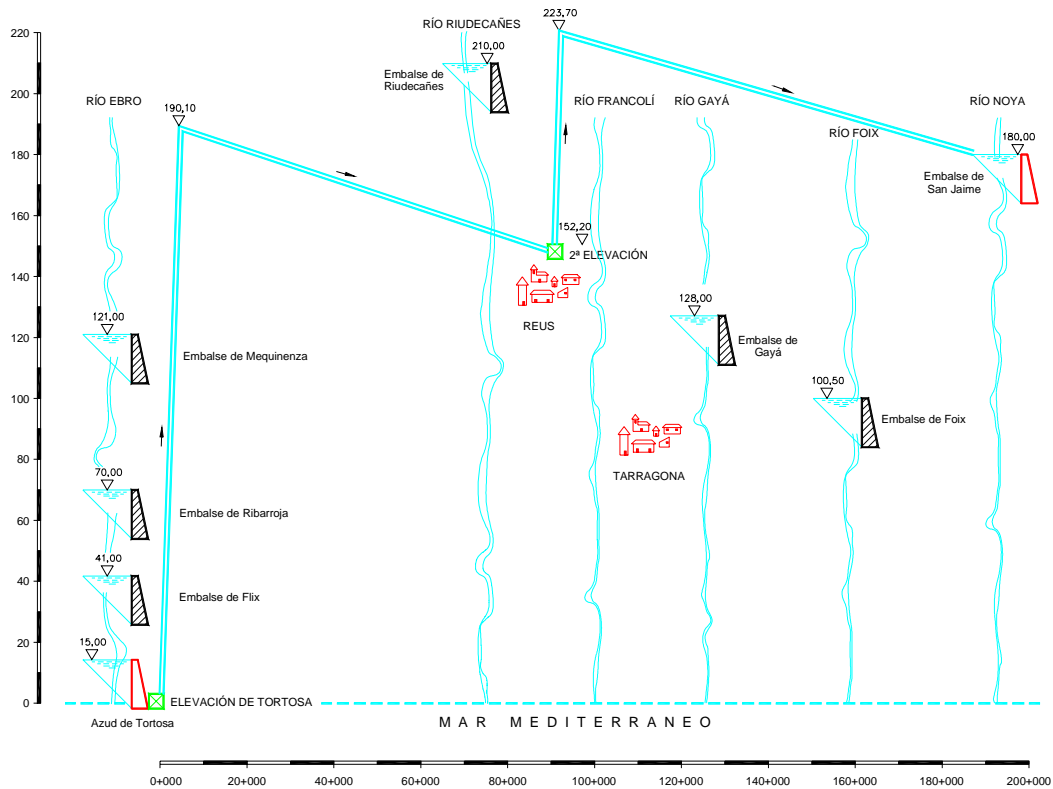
Conducción Ebro – Barcelona. Esquema en alzado
